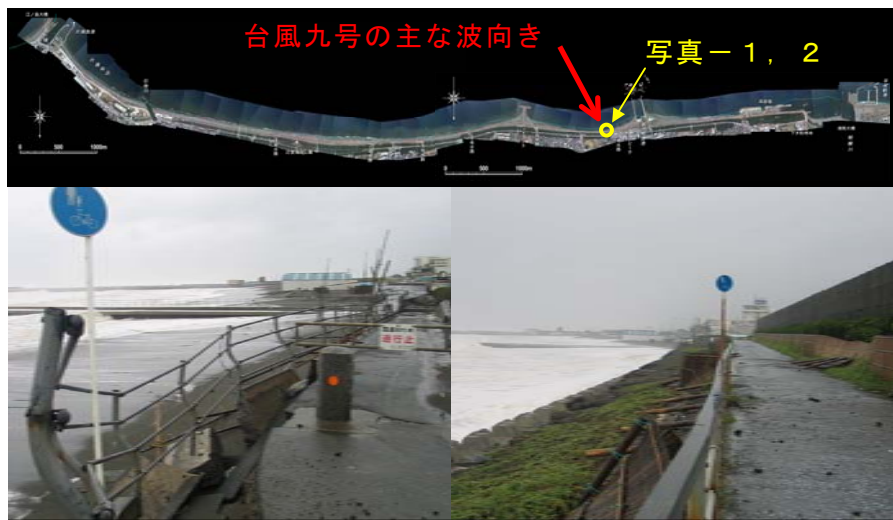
サイクリング道被災 写真-1 越波での竹ず柵倒壊
